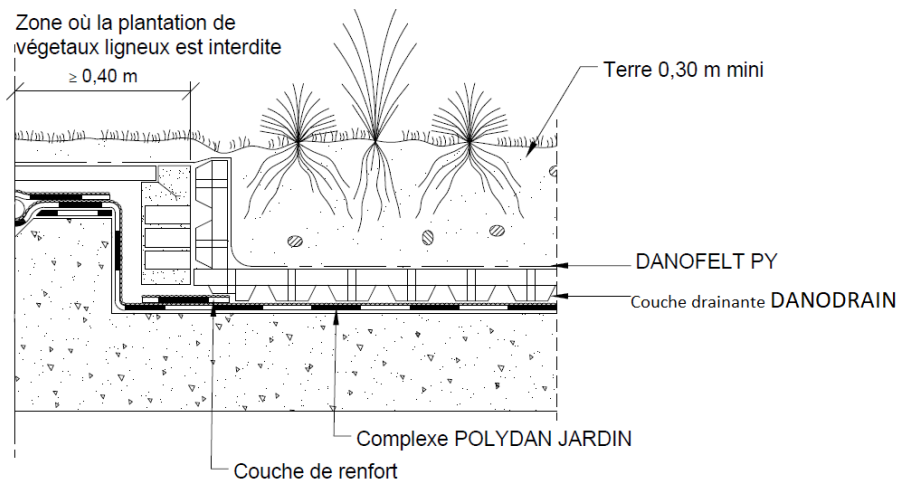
Exemple de traitement de joint de dilatation – Toiture-terrace-jardin - Élément porteur en maçonnerie
